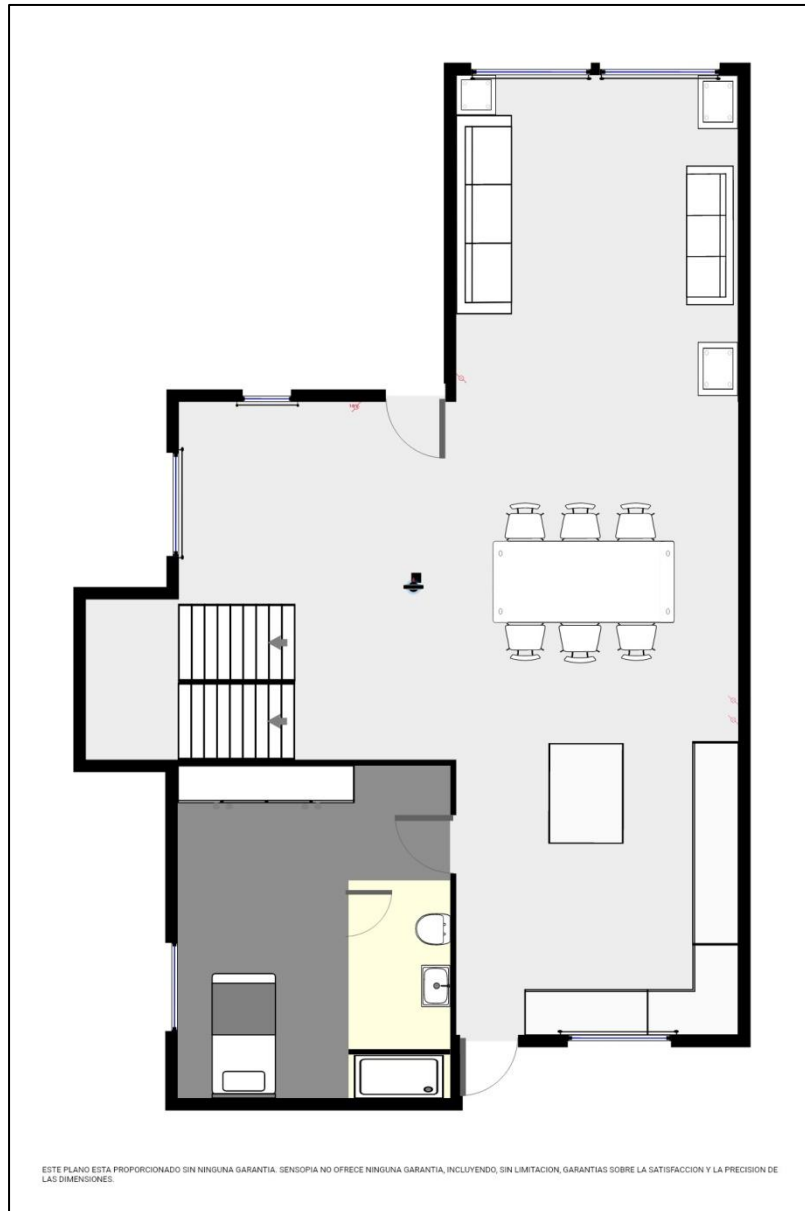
Planos de planta baja de las unidades de vivienda de la urbanización Royal Crown.
